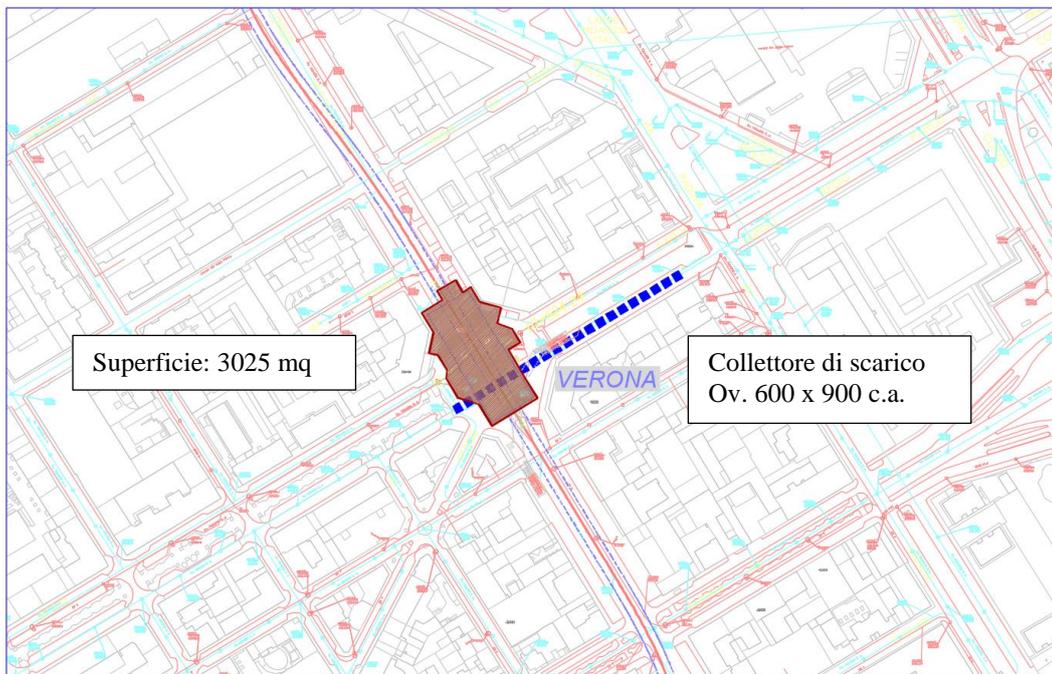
Aree di cantiere – Stazione Verona – FASE 1
